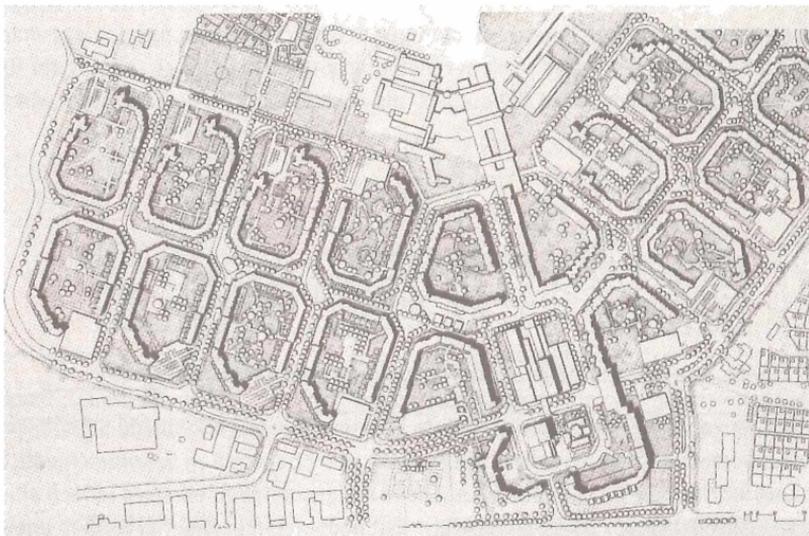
Grundriss der Siedlung Hamburg-Steilshoop
